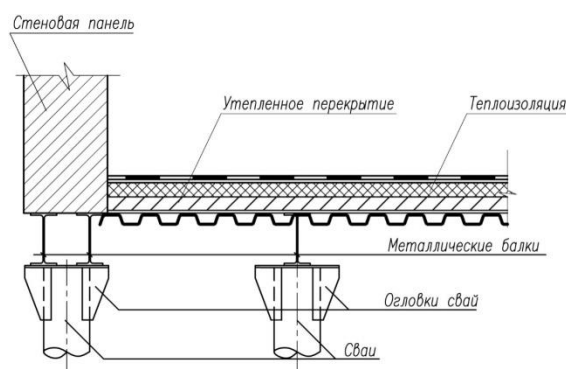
Конструкция цокольного перекрытия в виде металлической балочной клетки.
